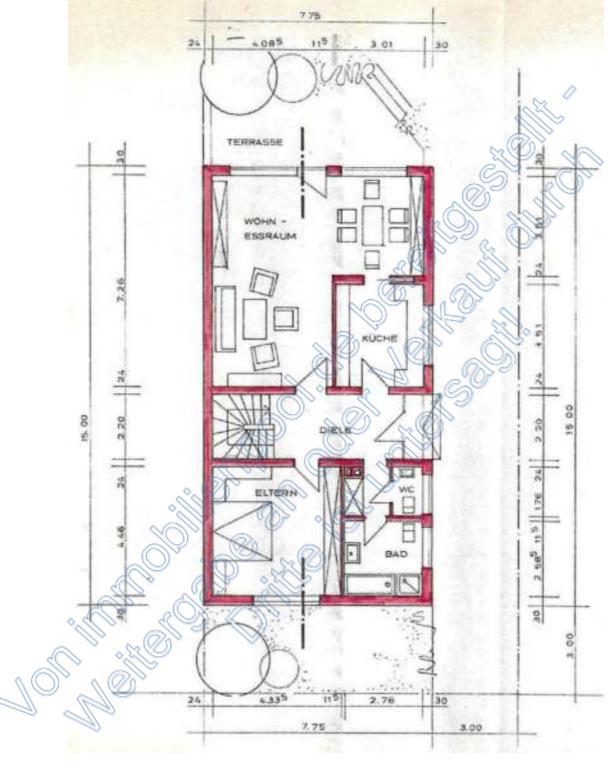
Grundrissplan Erdgeschoss (aus Bauakte 1973)
